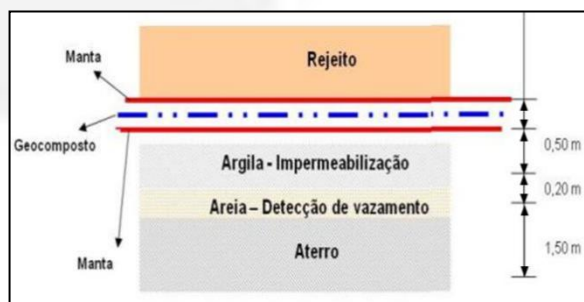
Sistema de impermeabilização e detecção de vazamento antigo.
